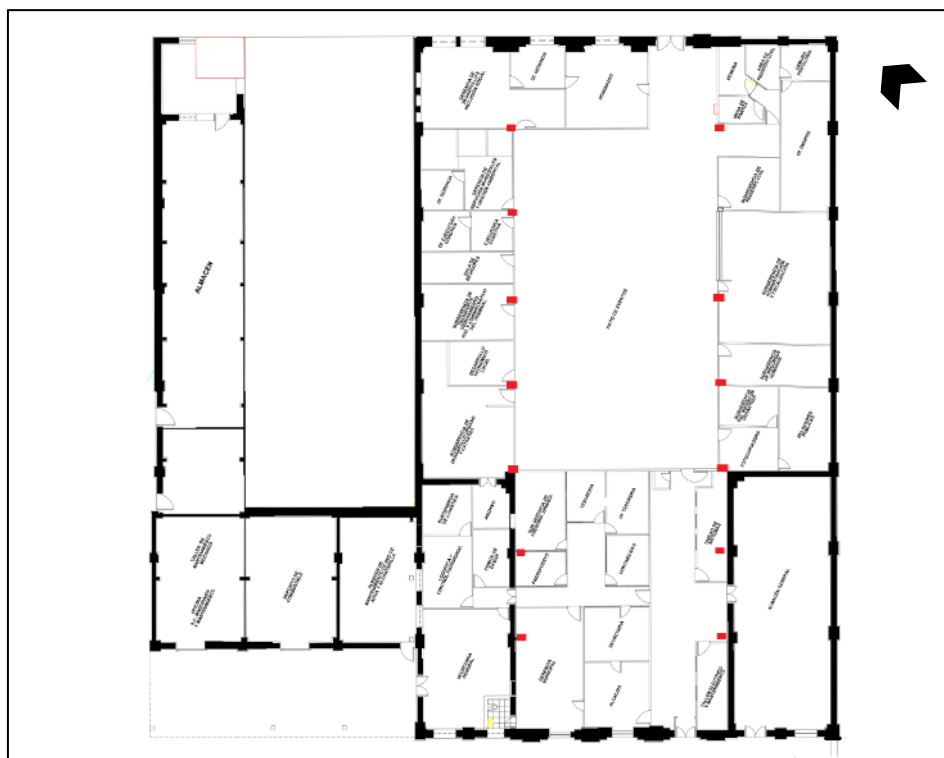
Plano elementos estructurales vigentes del Bazar
